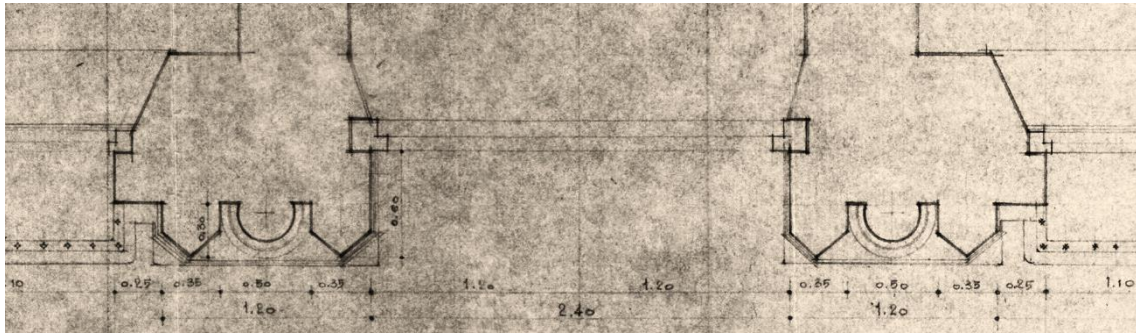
Planta de la fachada. Reconstrucción 1943 DNOA
